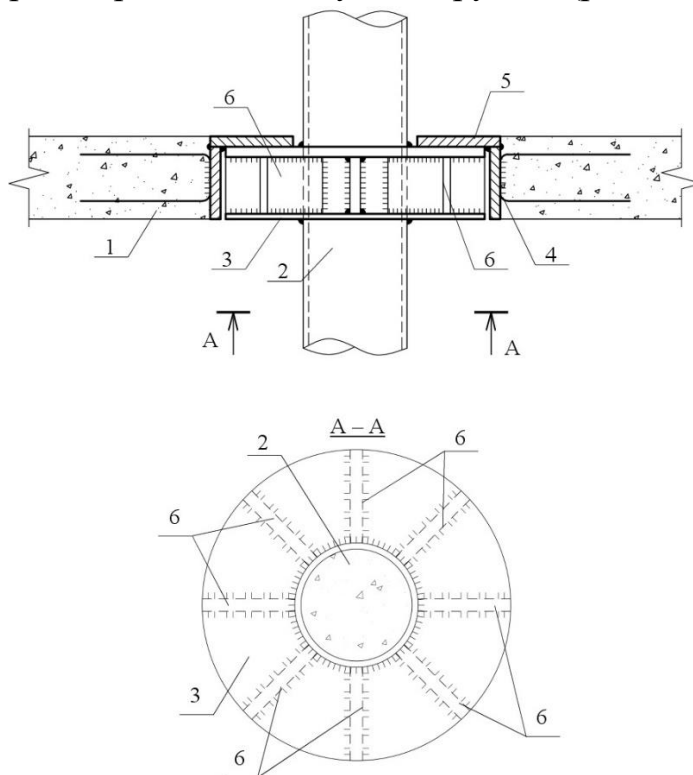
Конструкція захованого в товщу перекриття вузла з'єднання надколонної плити з колоною:
